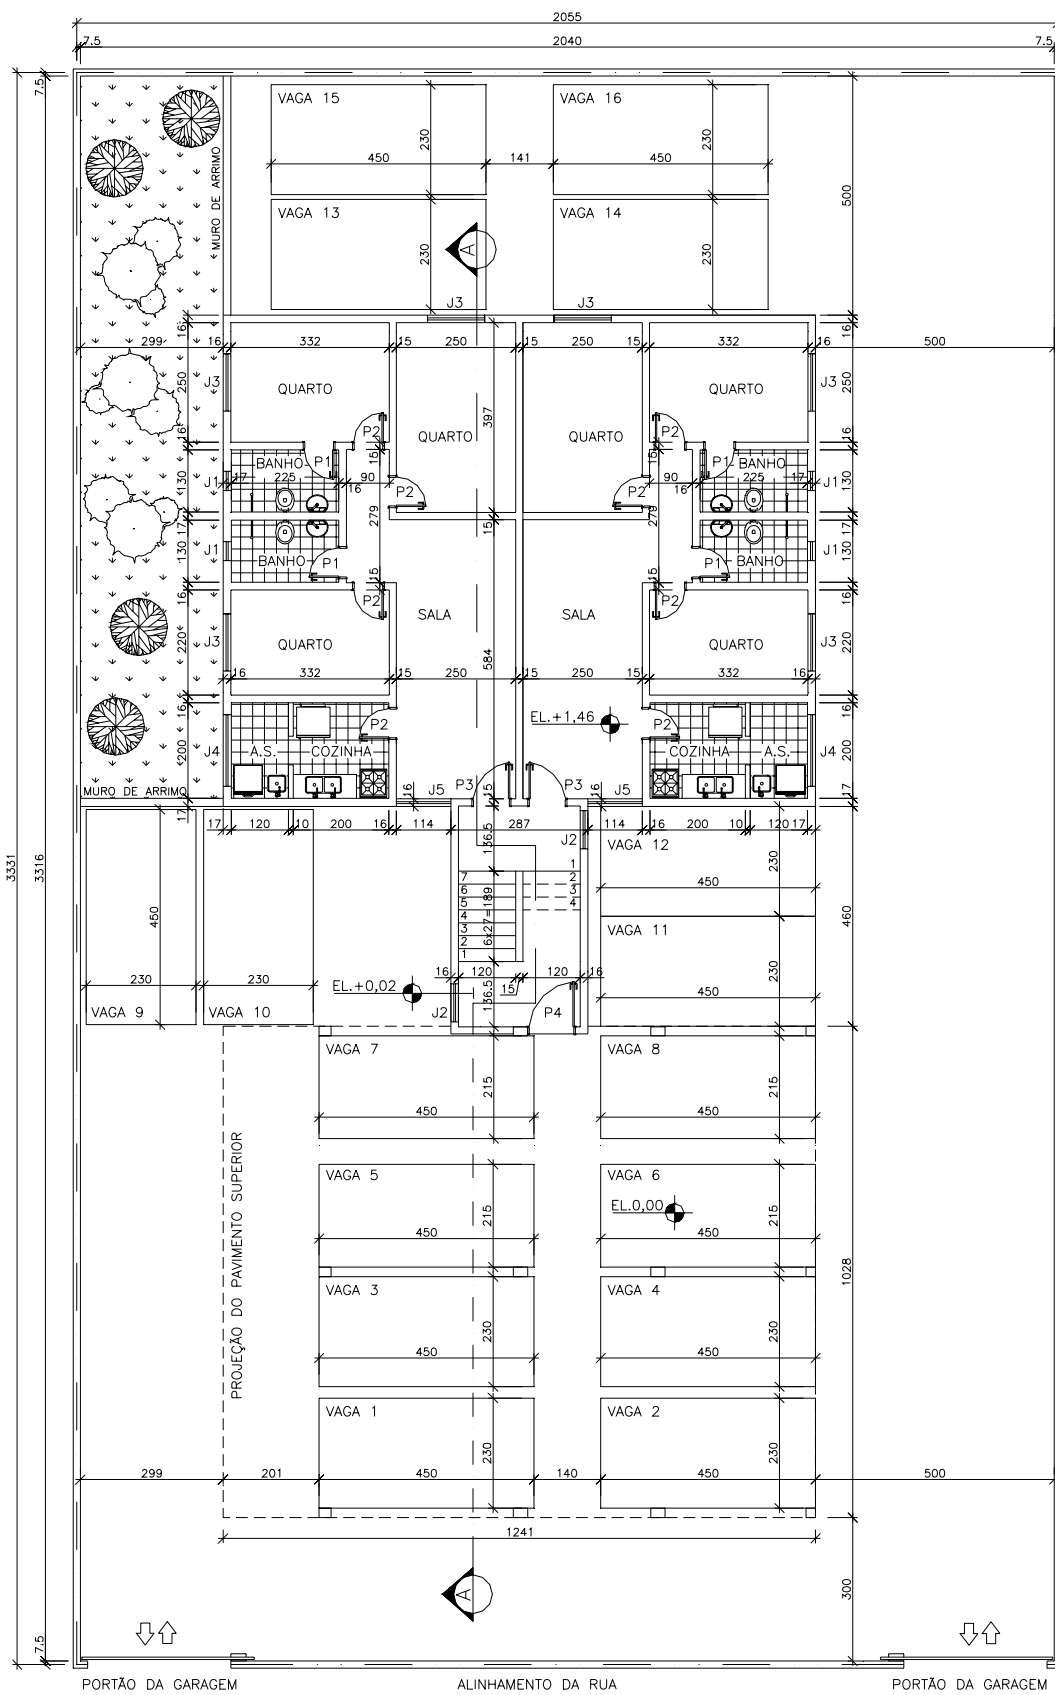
Prédio “C” – Opção 2 – Planta da garagem
